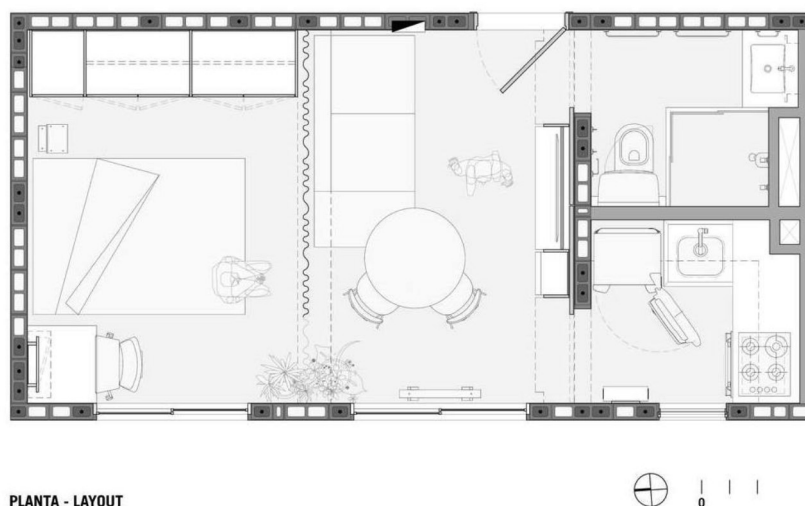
Planta do Apartamento General Jardim | Bruno Manso
